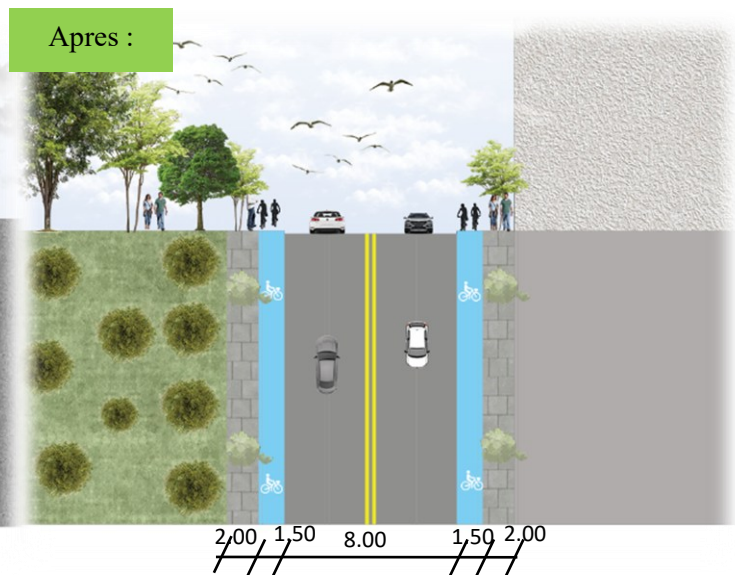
plan et coupe de boulevard Chabane Ahcene après l'intervention.
